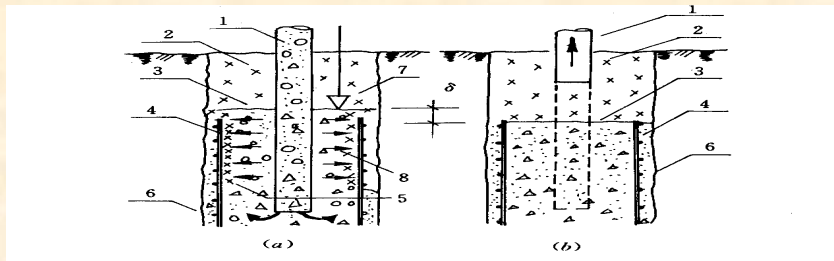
钻孔灌注桩混凝土顶面下降原因示意
